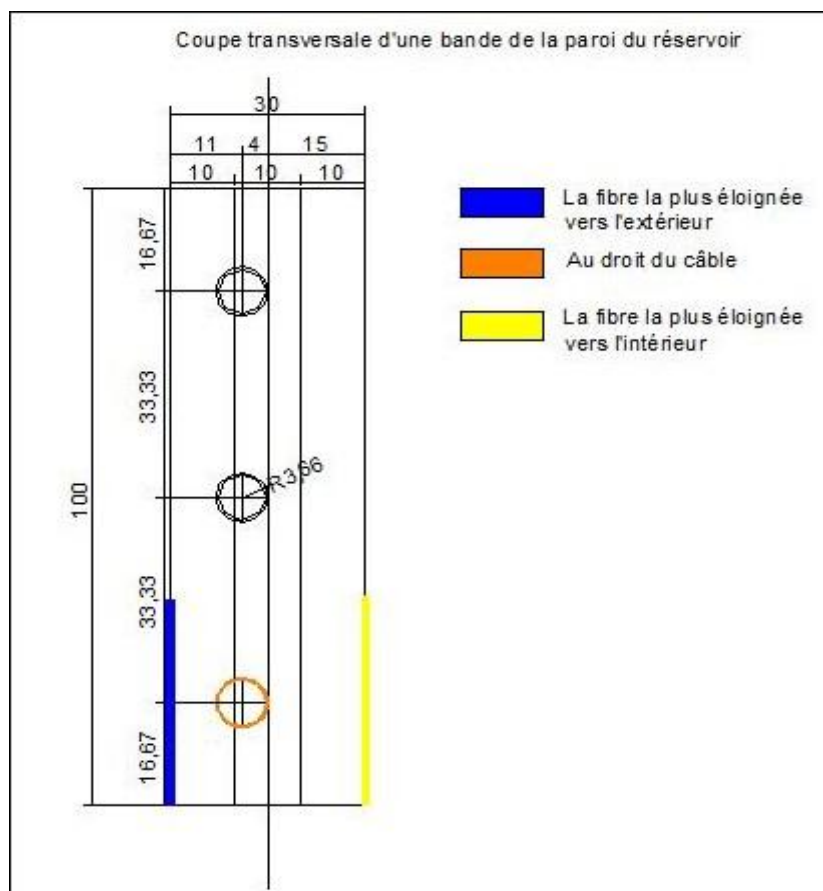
coupe transversale dans la paroi au niveau d'une bande
